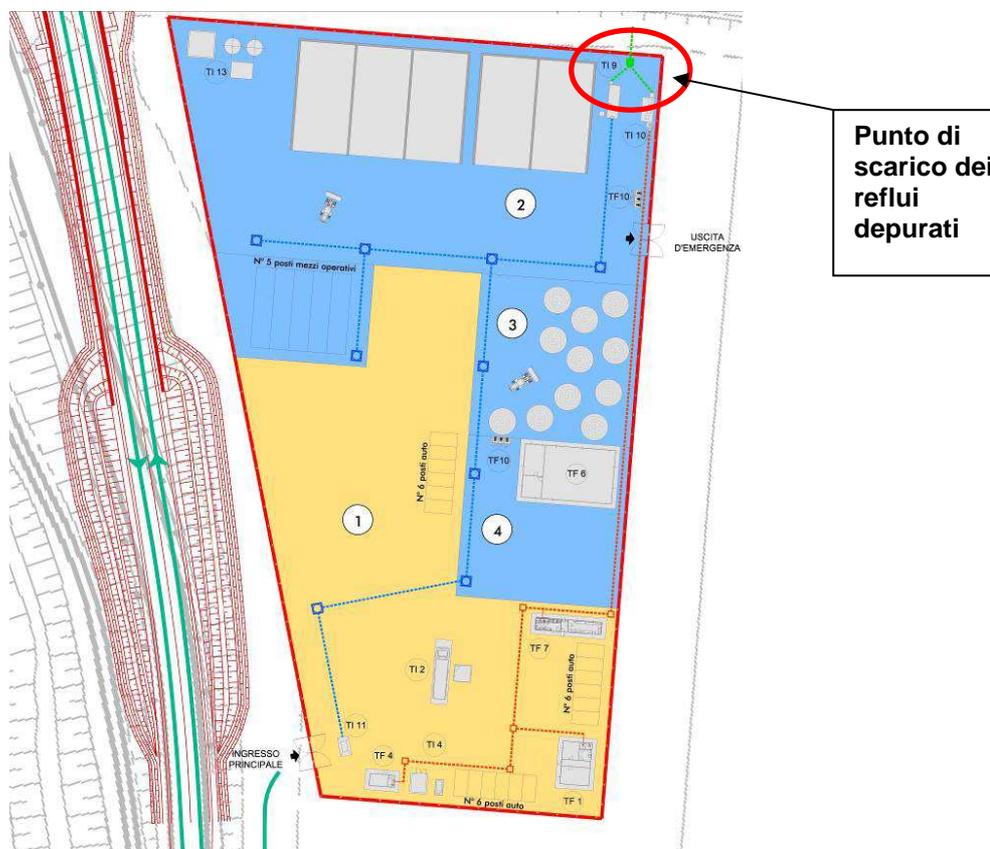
PLANIMETRIA DELL'AREA TECNICA CON INDIVIDUATO IL PUNTO DI SCARICO
